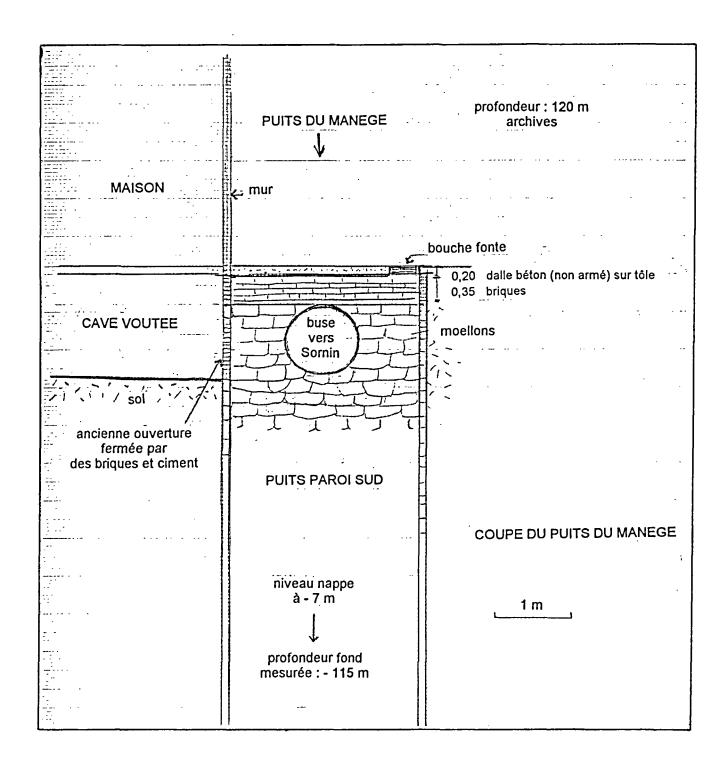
Coupe du puits du Manège - échelle 1/50
